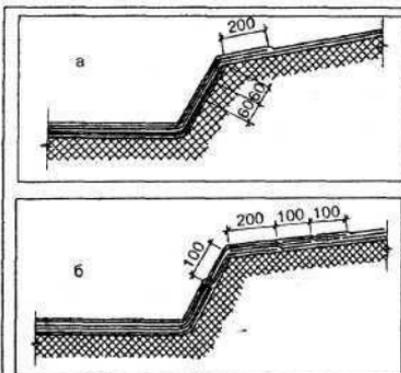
Рулонные кровли. Покрытие ендов и разжелобков:
